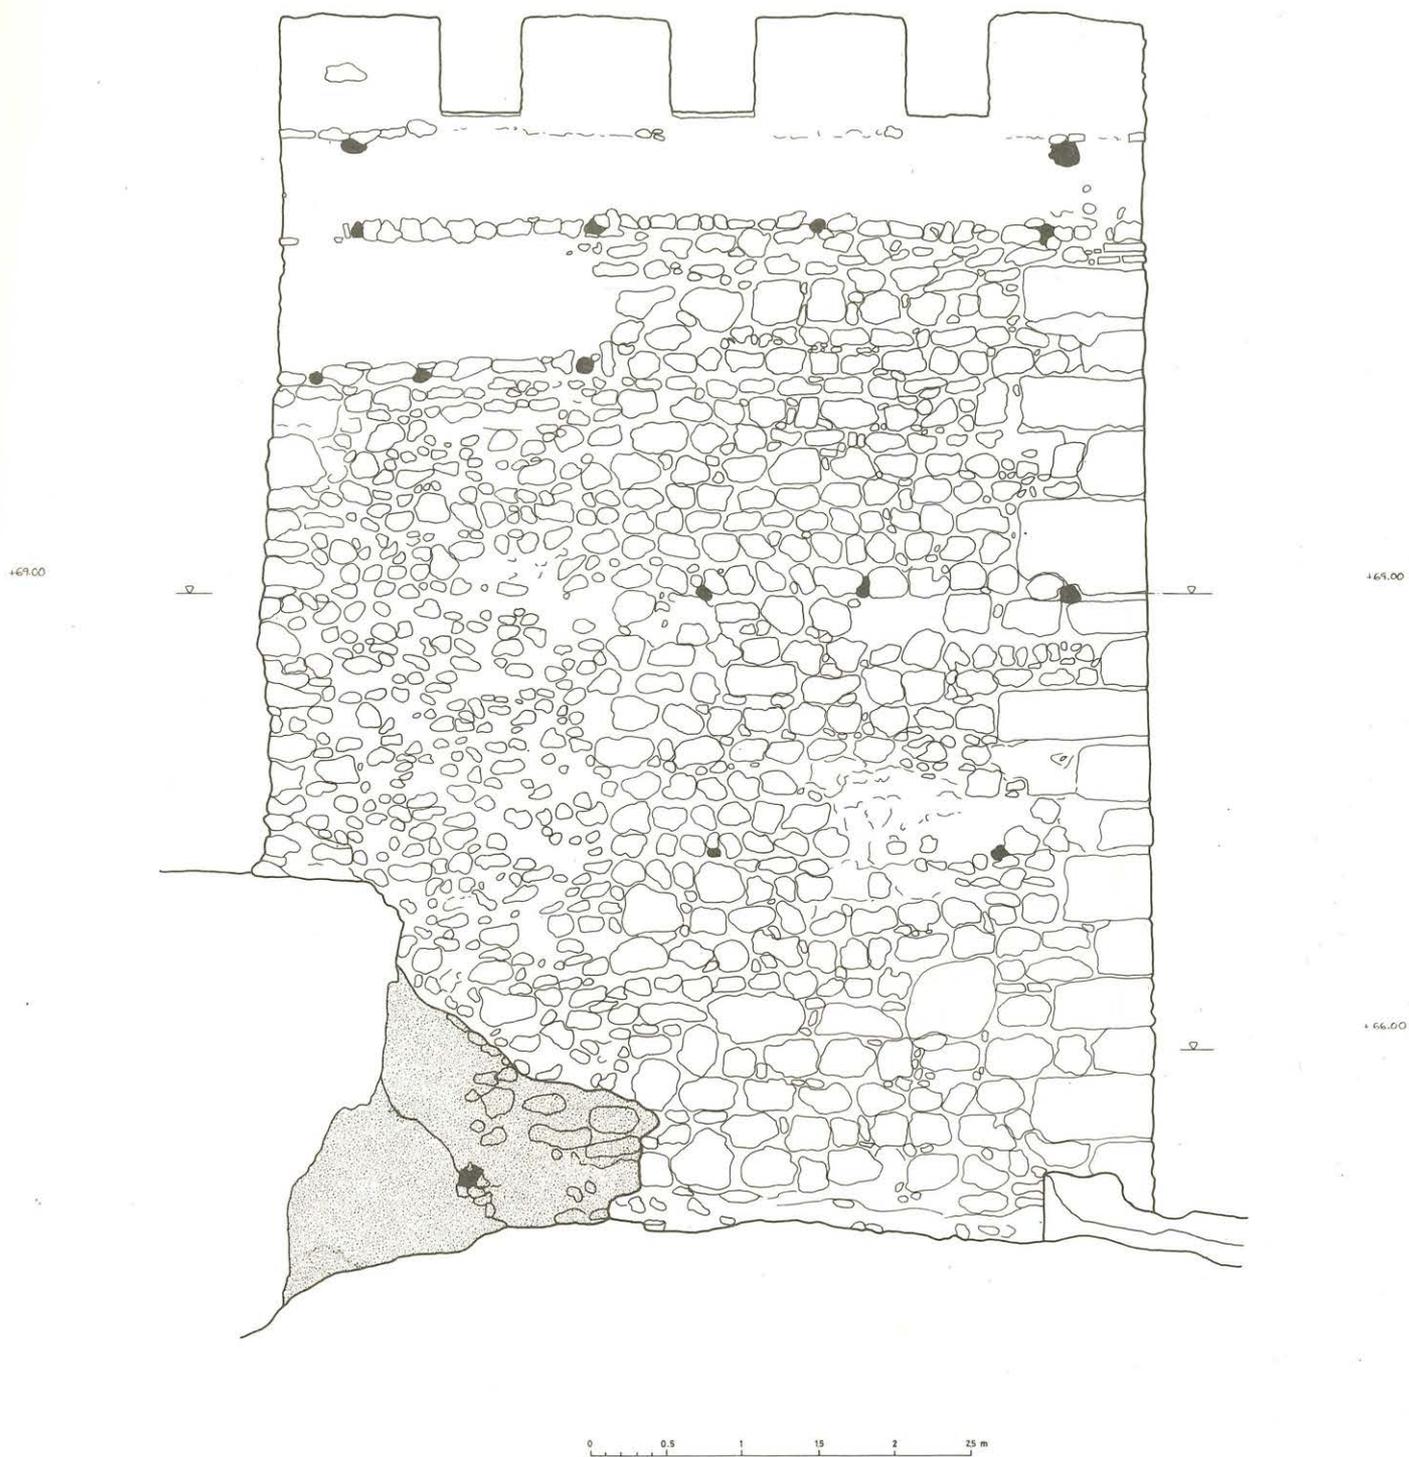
Alzado este de la Torre B. Ibidem autor.
